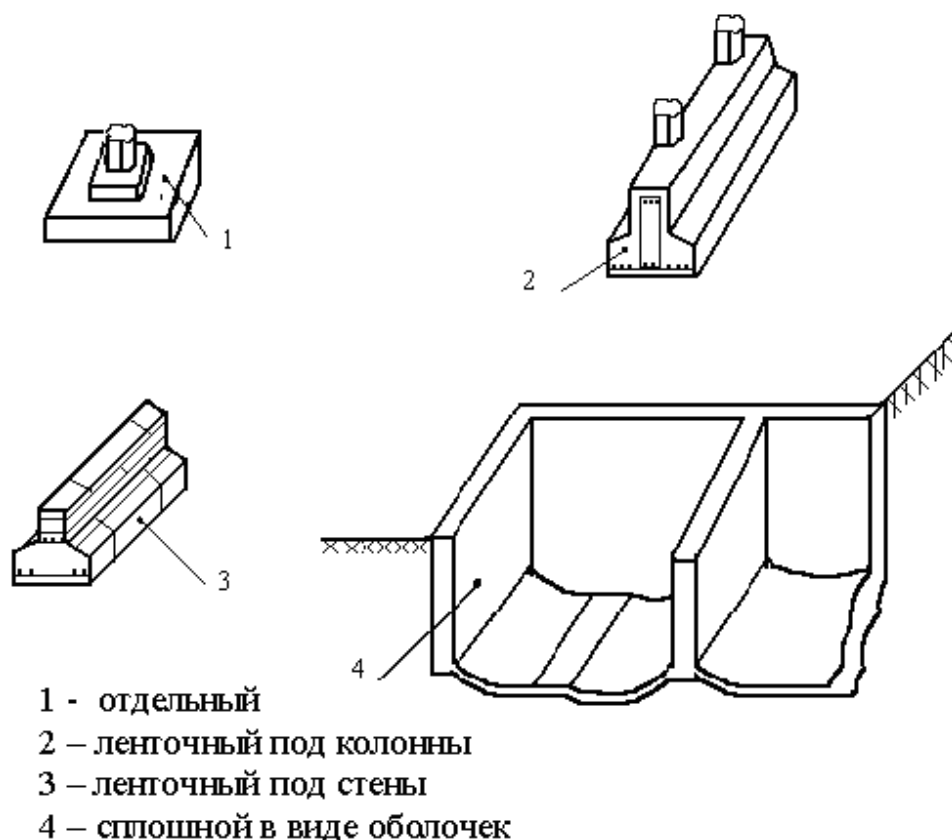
Типы фундаментов, устраиваемых в котлованах
